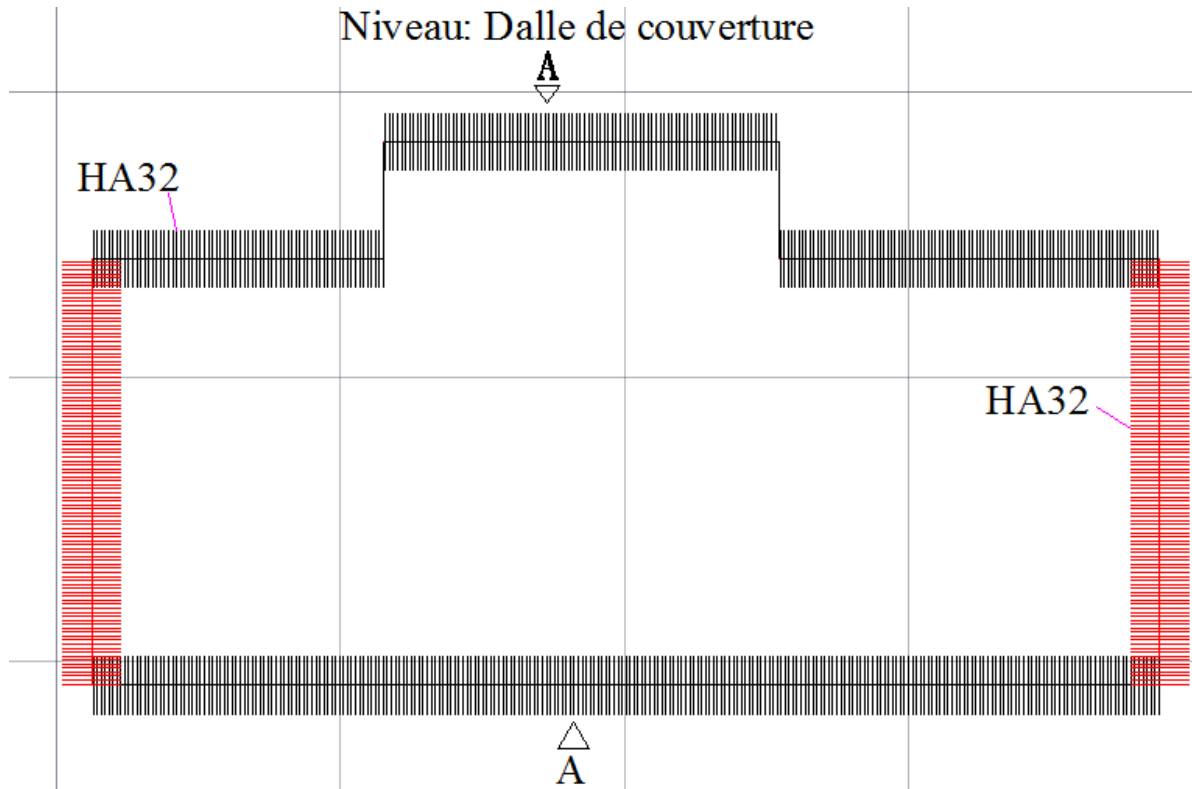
Schéma de ferrailage sur appuis de la dalle de couverture(Nappe inférieure)
